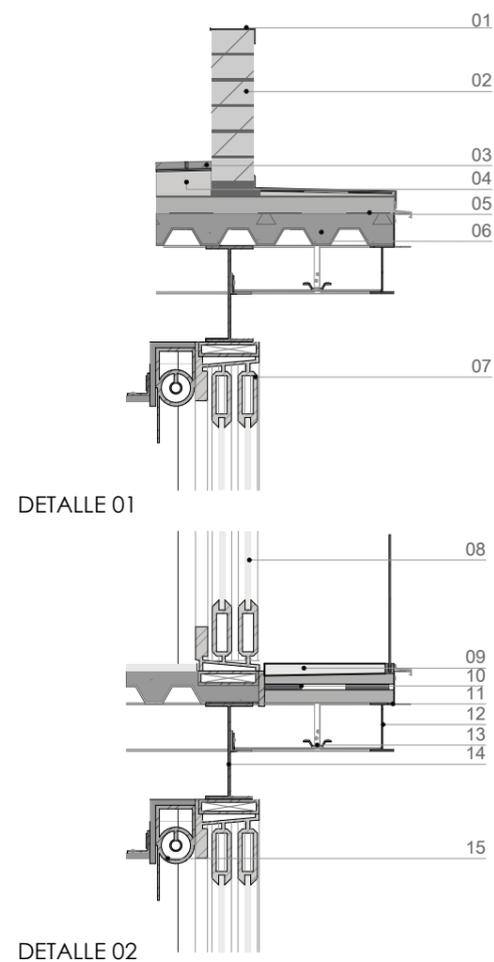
y 98: Detalle constructivo Fuente: Elaboración propia
